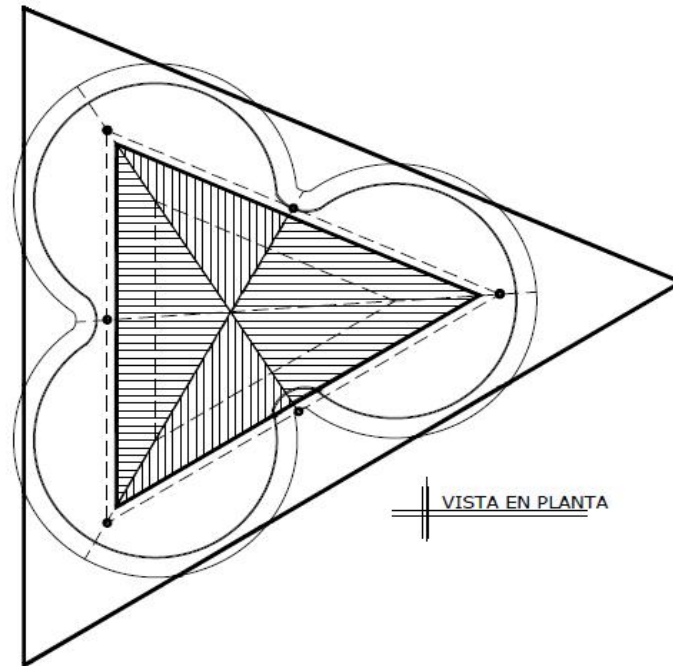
4 Vista en planta de la isla de descanso propuesta. Departamento de Arquitectura y Arte UTPL [17]
